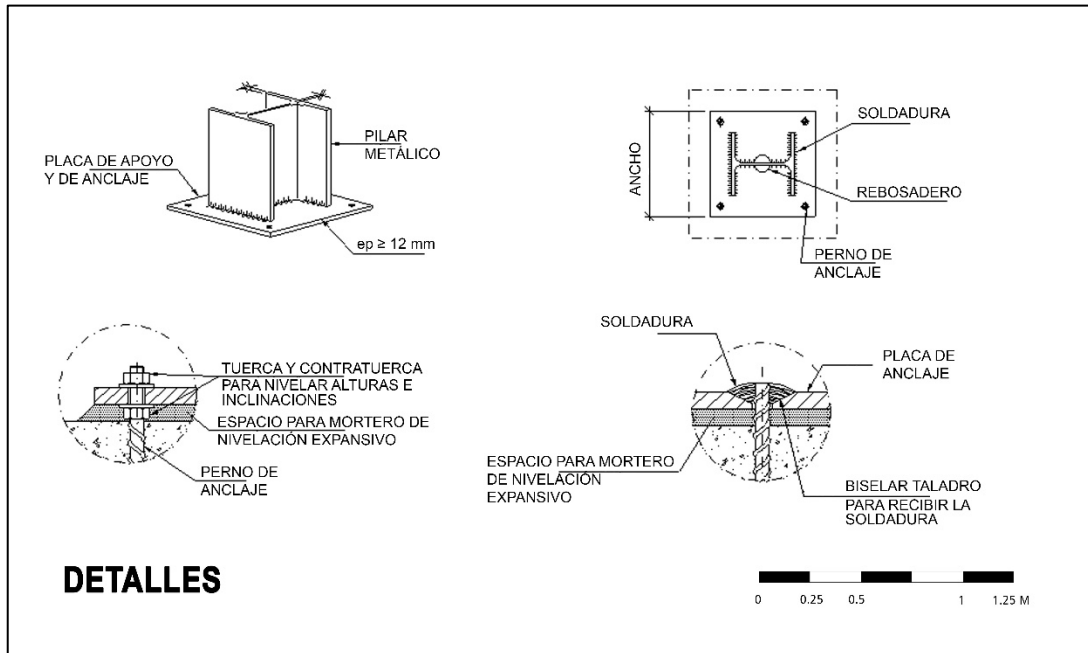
Detalles de zapata aislada y de pilar metálico
